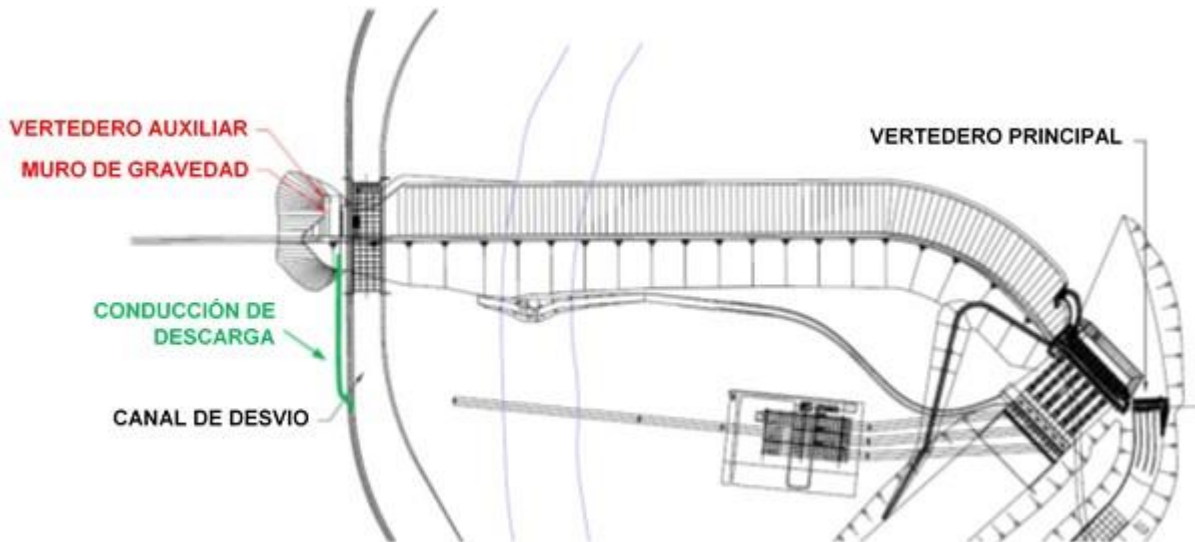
Implantación general con Vertedero Principal y Auxiliar.
